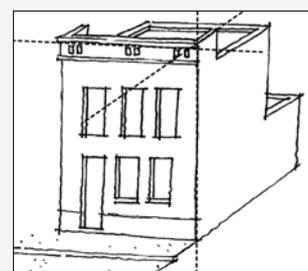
C : intersection du plan de façade et du plan de toiture – cas d'une construction avec toiture plate comportant des murs acrotères.
